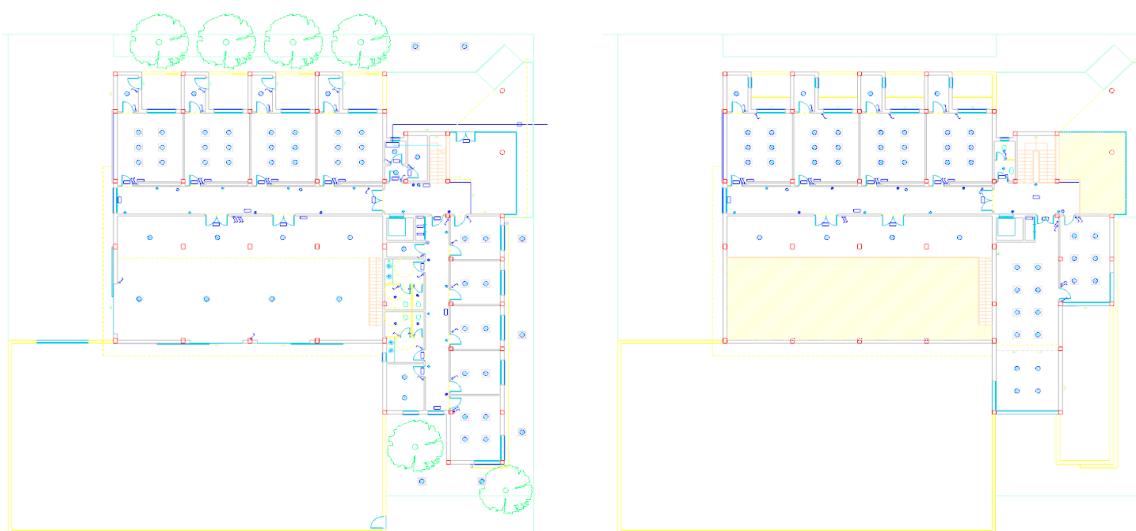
Plano de la planta baja (izquierda) y primera planta (derecha) del C-DdI-CIESOL-ARFRISOL en Autocad.
